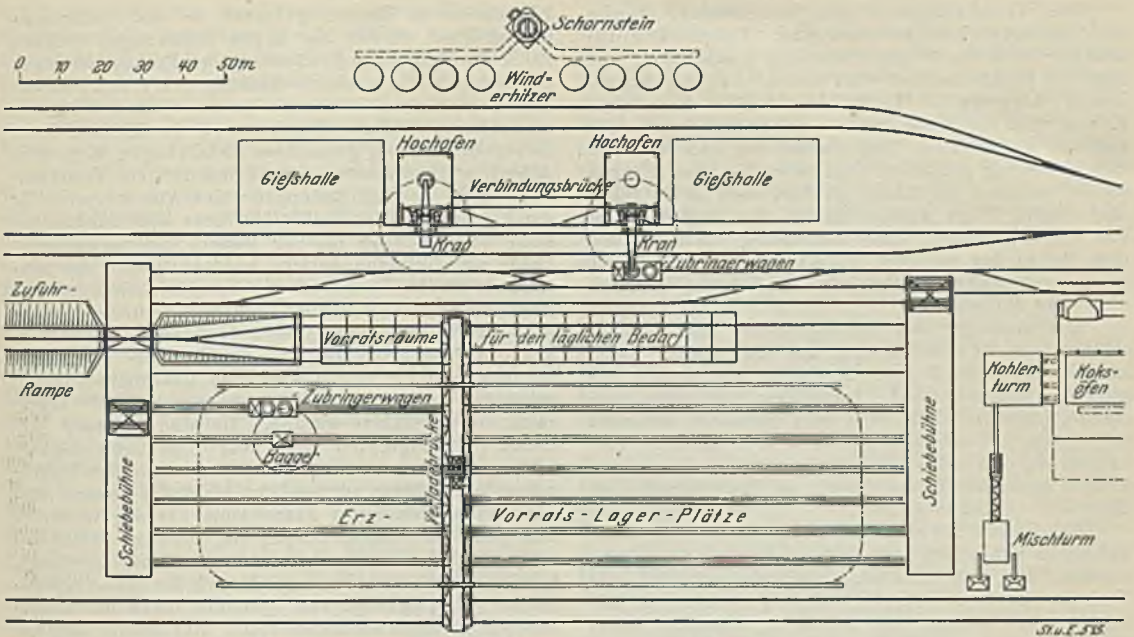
Grundriß der Hochofenbeschickung durch fahrbare Schwenkkrane.
